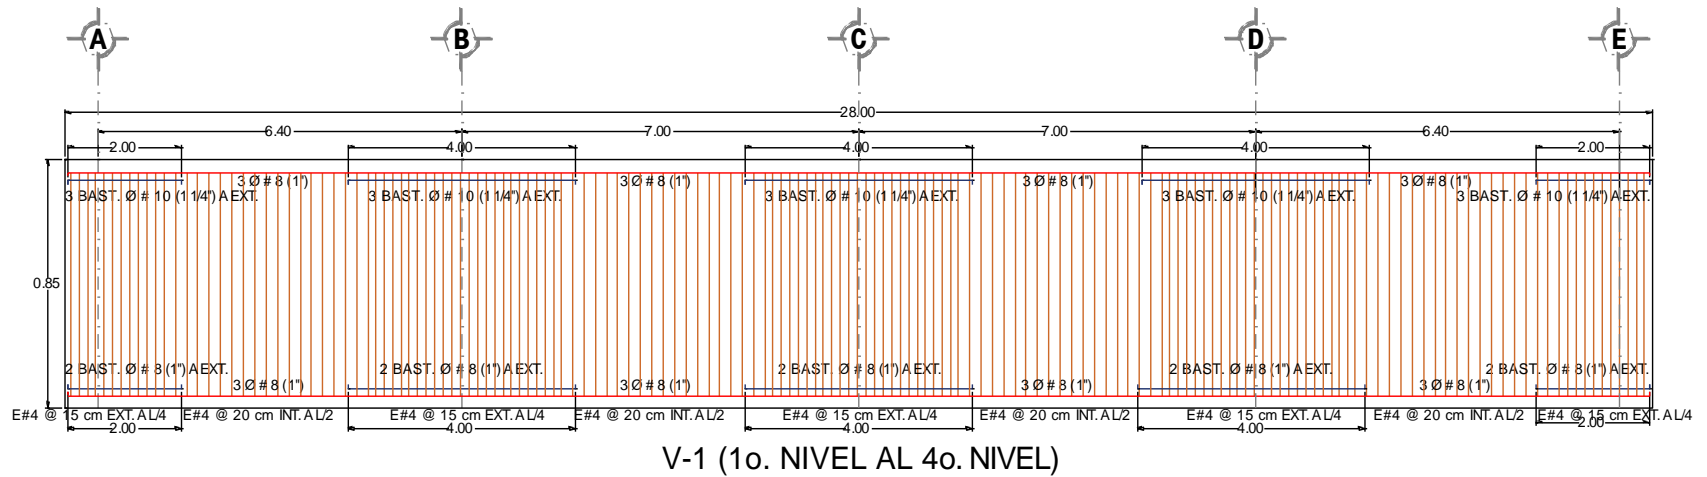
Detallado de armado de vigas y columnas del marco de 9 niveles con base a la hipótesis de las NTCC-17.
